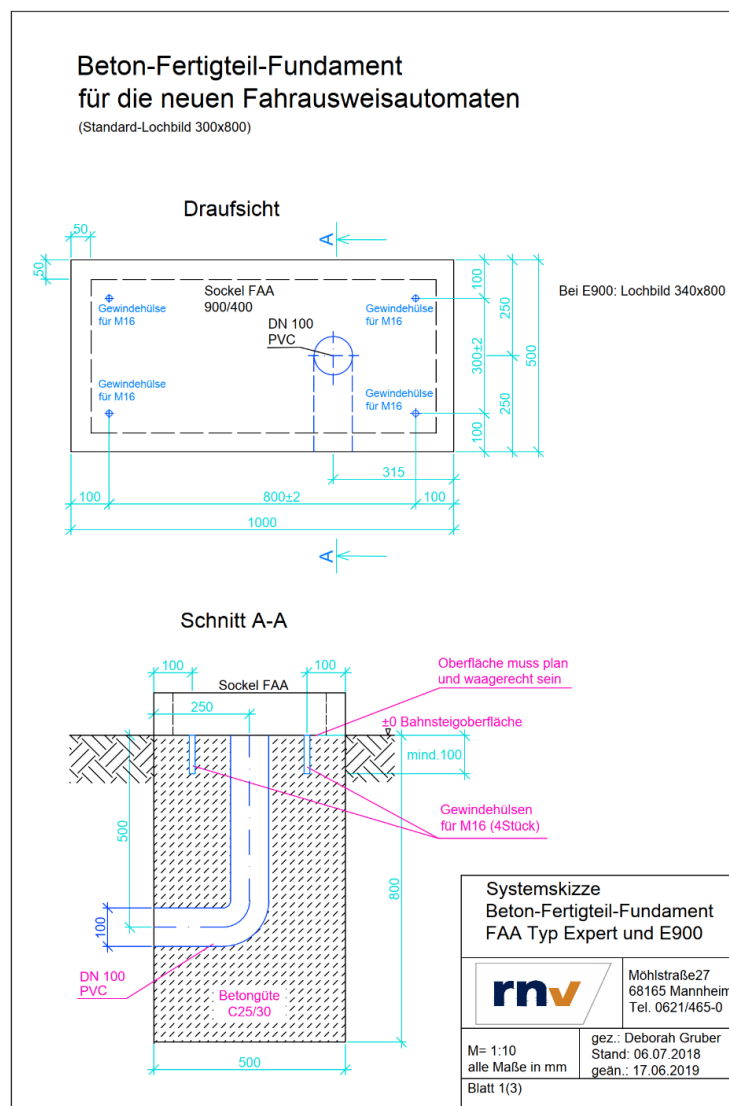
Systemskizze Beton-Fertigteil-Fundament FAA
